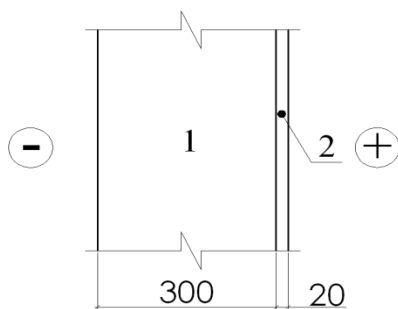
Конструктивная схема наружной стены для производственного здания без утеплителя
